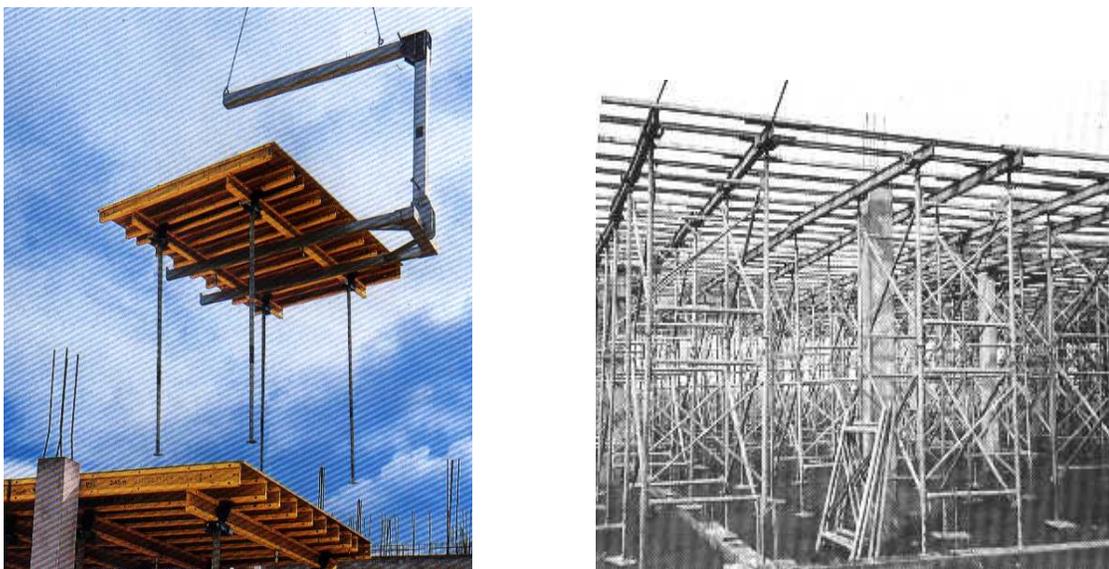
Sistema tramado para lajes: a) transporte de mesa voadora (Doka, s.d.); b) vigamento superior e inferior em aço, apoiados em torres metálicas.
